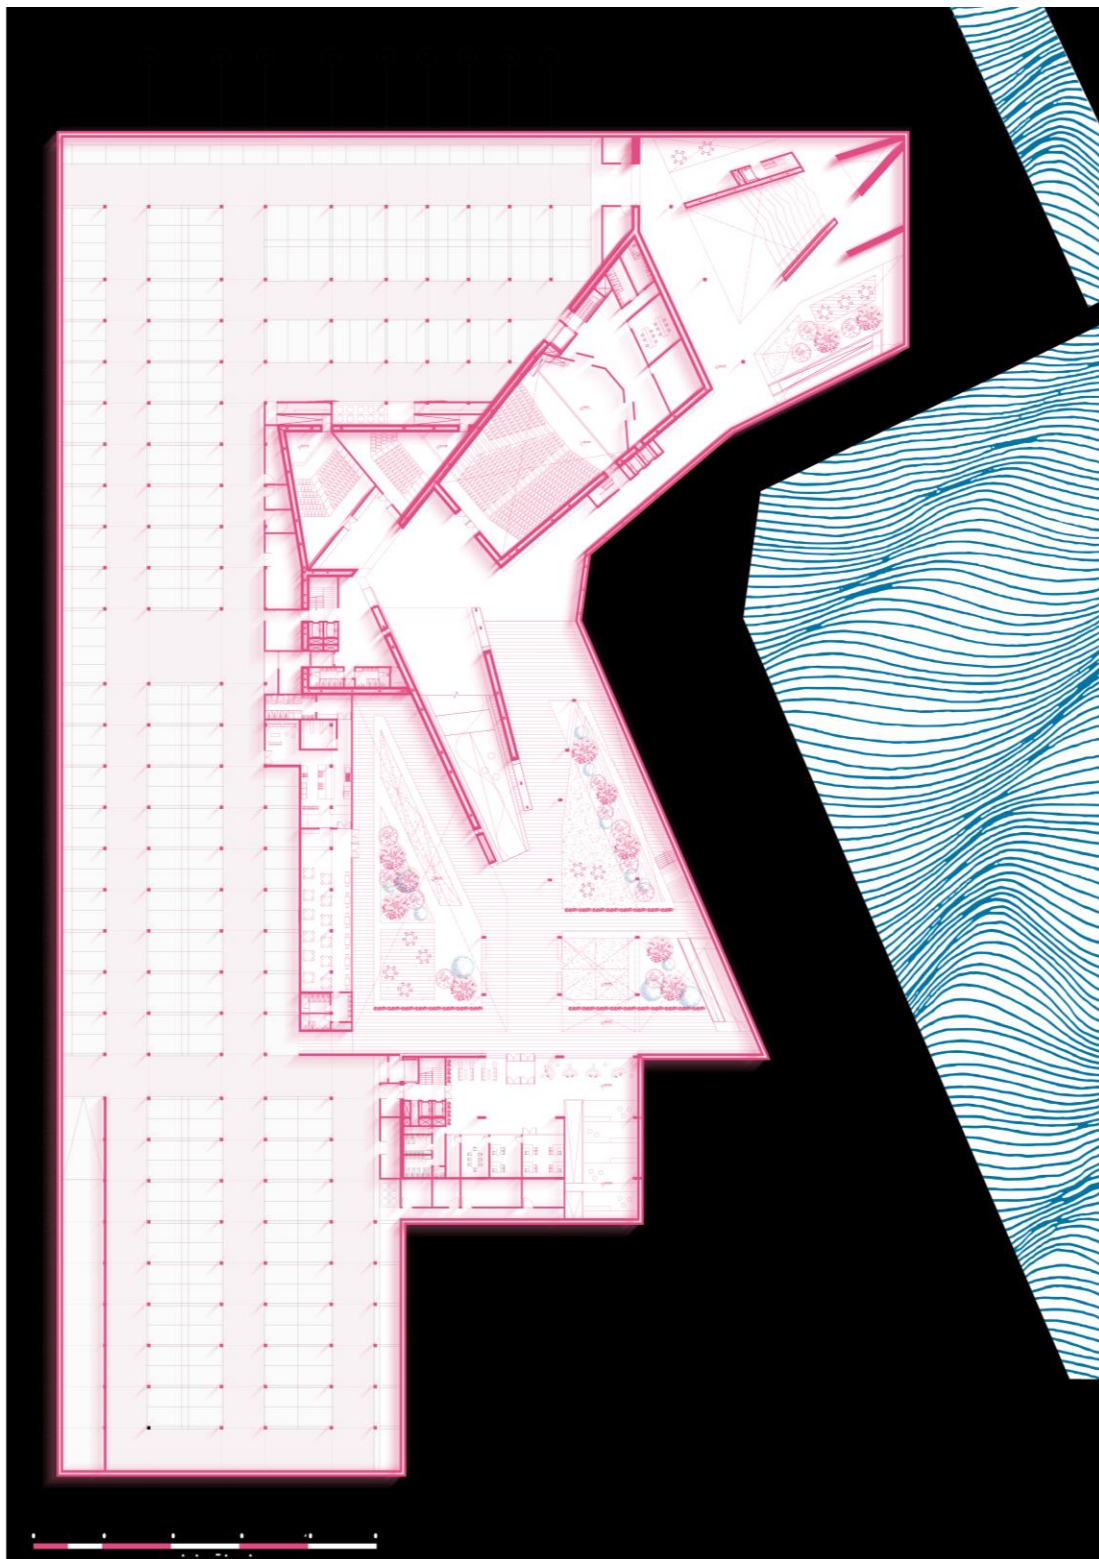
Planta Subsuelo N - 3.57. Elaboración propia
